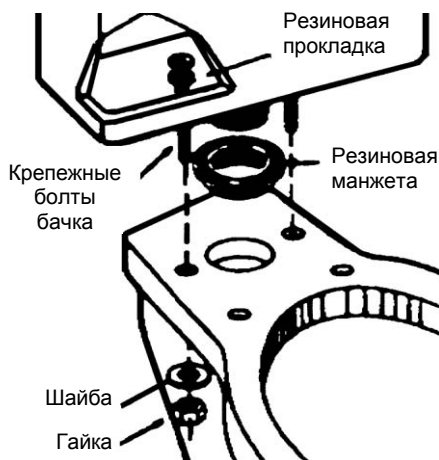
Монтаж бачка без предварительно установленных болтов (American Standard)
